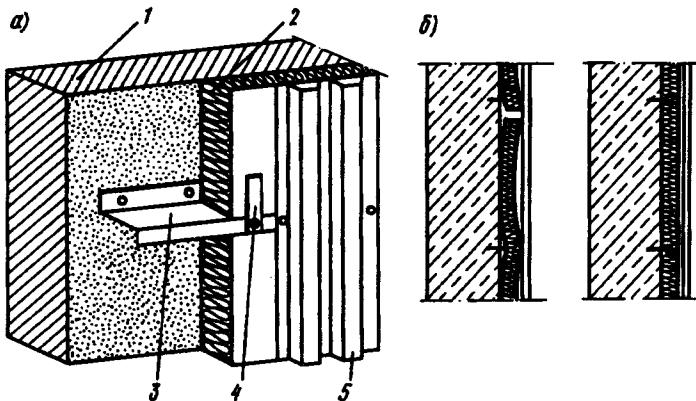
Крепление утеплителя из минераловатных плит к бетонной стене
